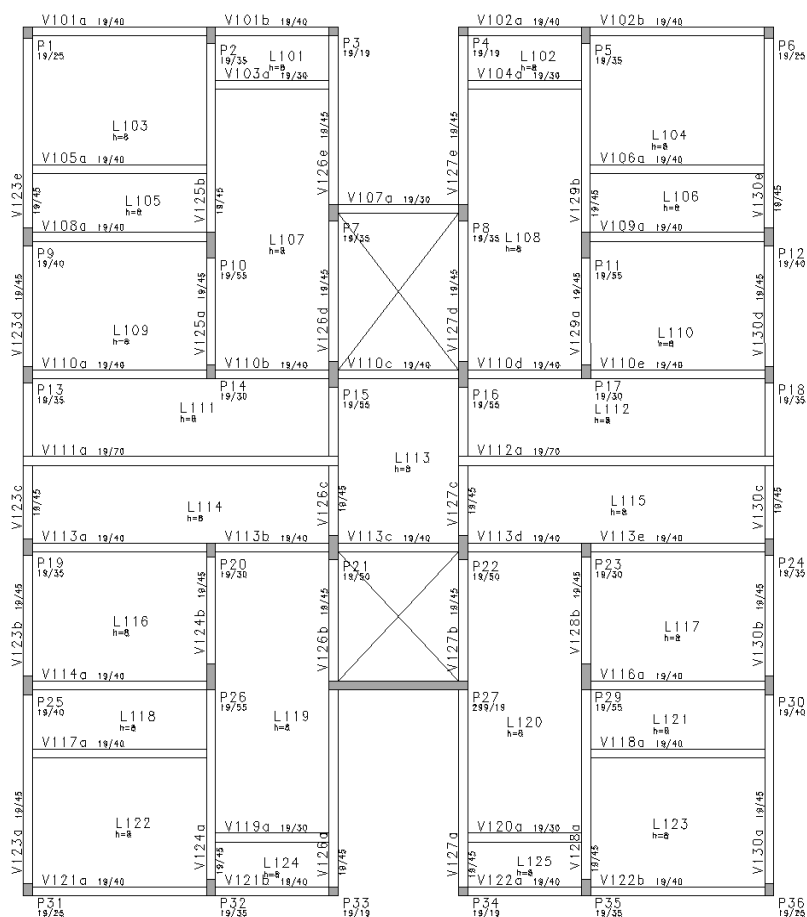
Lançamento e Concepção Final da Estrutura Convencional (Lajes, Vigas e Pilares) -Fonte: Adaptado do CAD/TQS (2016).
